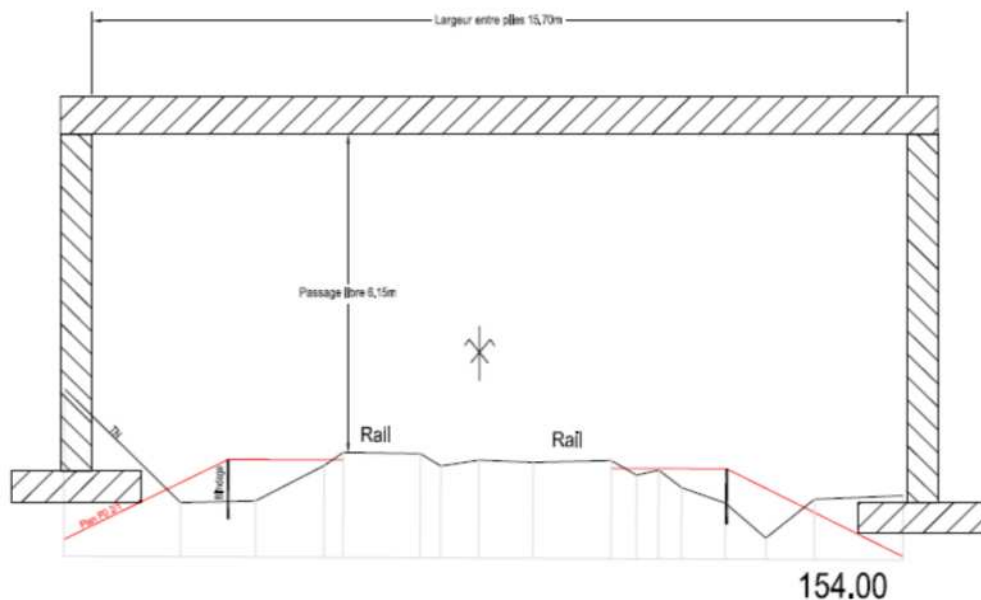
Coupe de principe de l'ouvrage de franchissement
